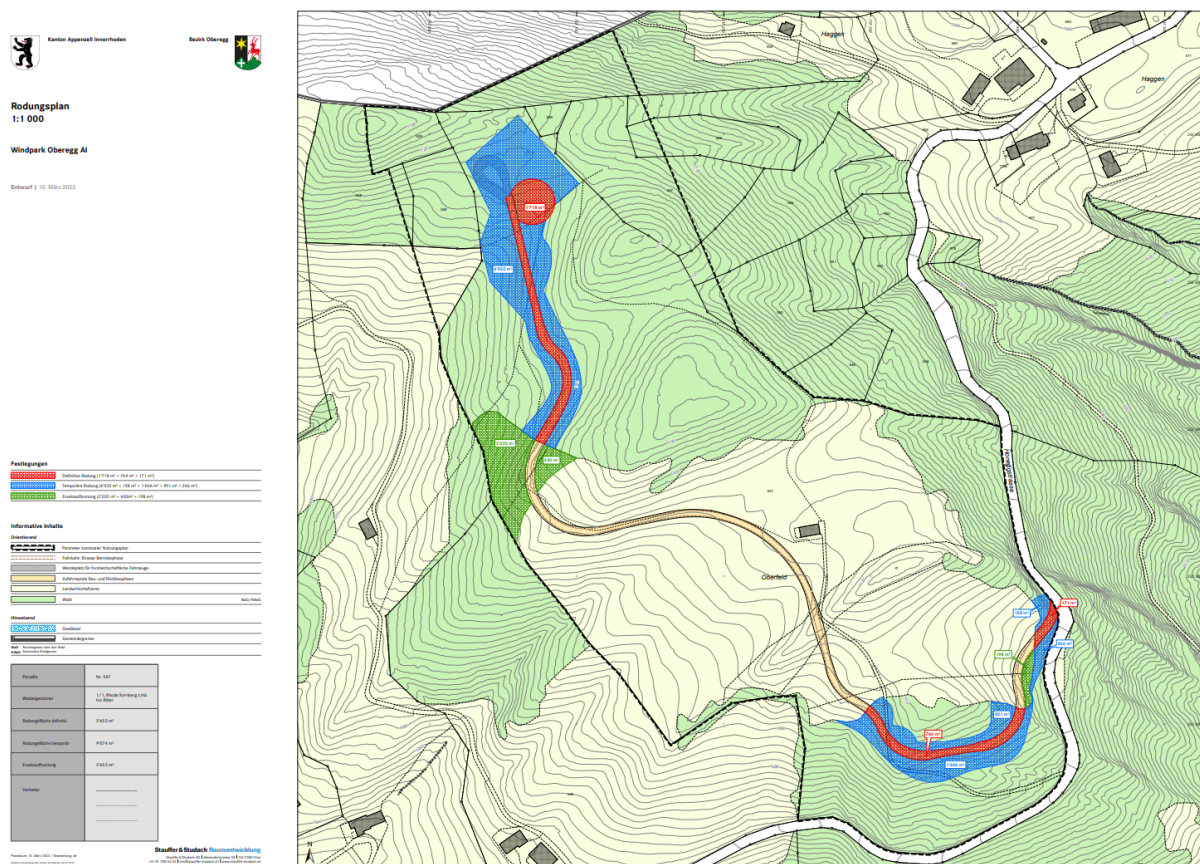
Rodungsplan mit Zufahrtsstrasse ab Haggenstrasse. (Quelle: Rodungsplan Windpark Oberegg AI Entwurf, Stauffer & Studach AG, dat. 10.03.23)
